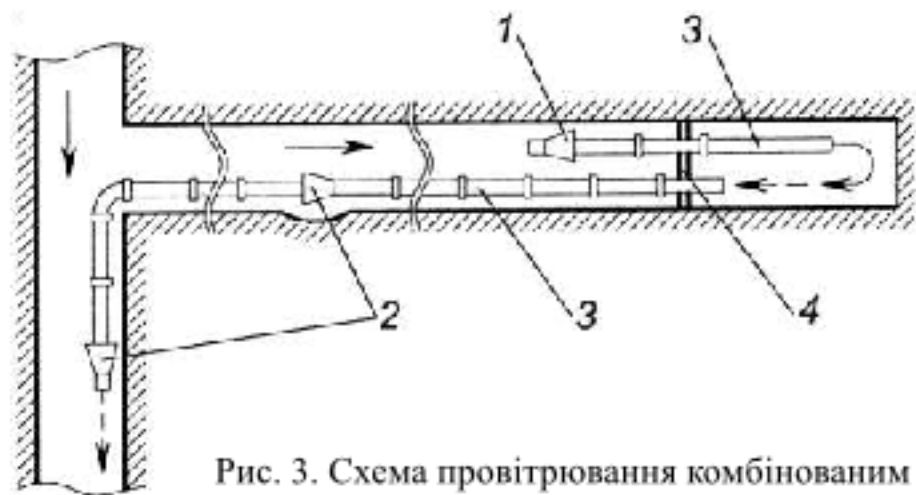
Схема провітрювання комбінованим способом тупикової виробки з перемичкою: 1 - нагнітальний вентилятор; 2 - всмоктуючий вентилятор; 3 - трубопроводи; 4 - перемичка.
